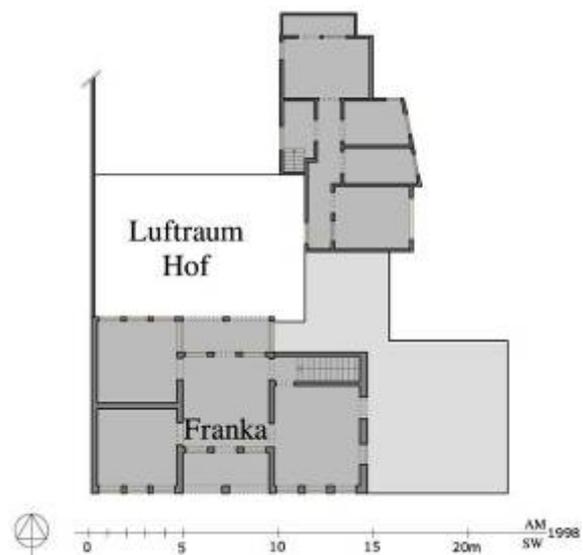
Bayt Bizm, Grundriss 2. OG
